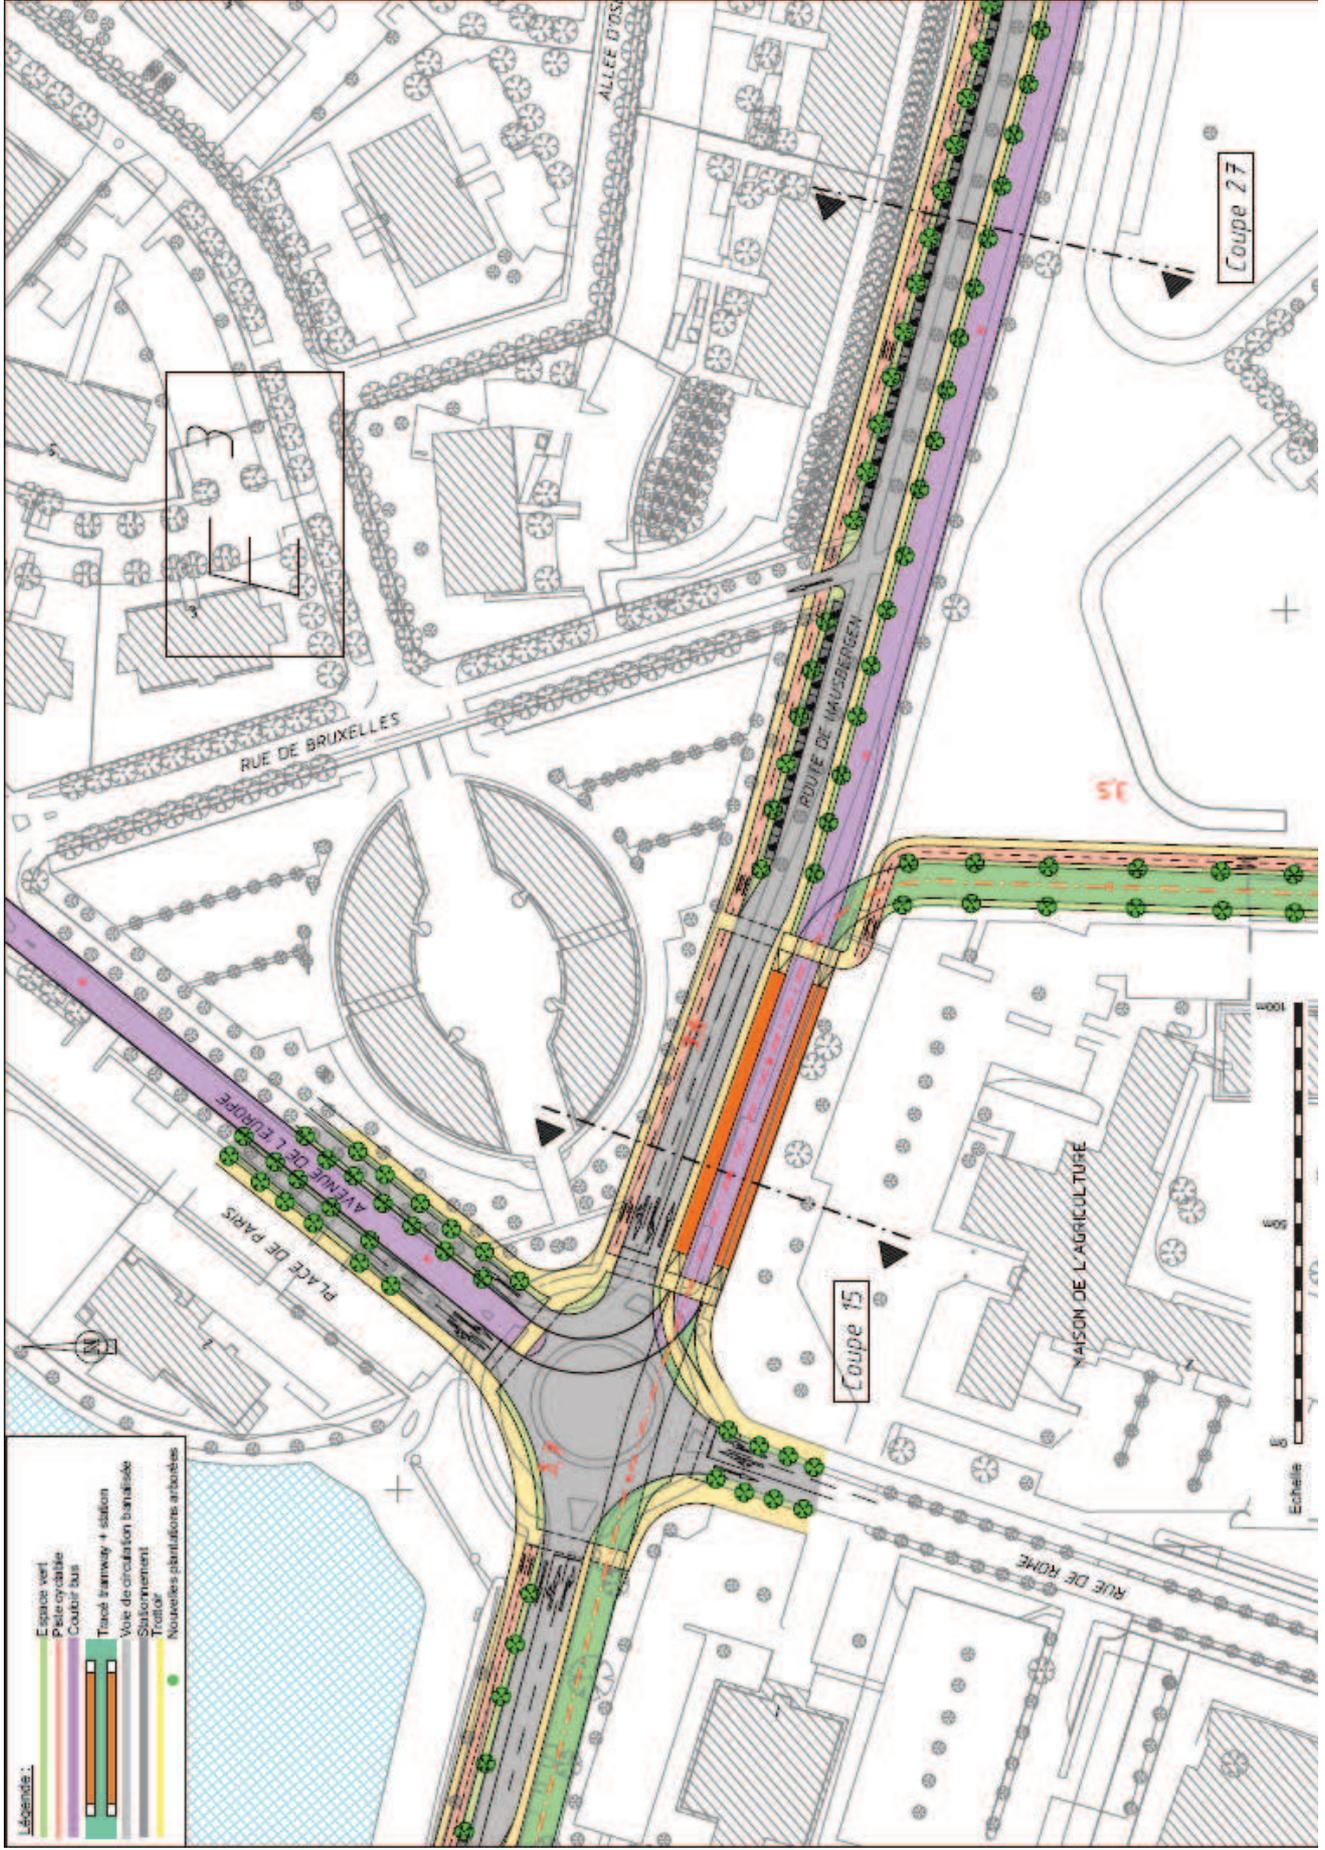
Zoom d'insertion secteur route Hausbergen / avenue de l'Europe
